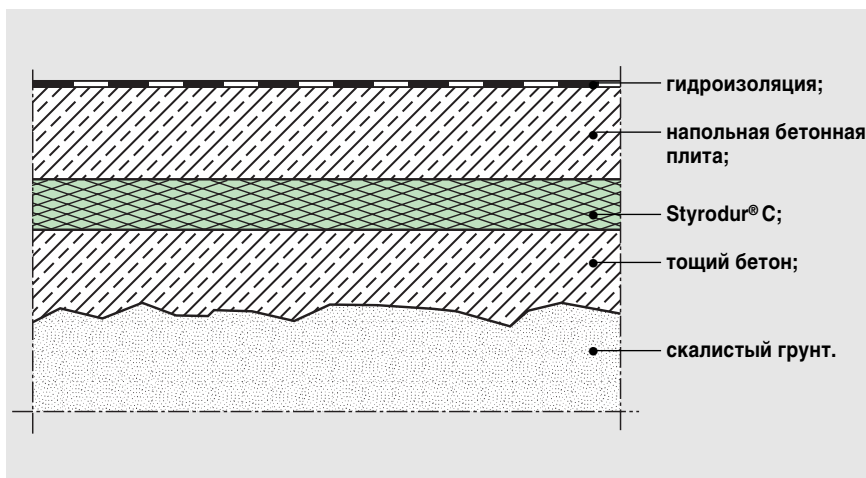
Выравнивающий слой из тощего бетона в строительном скалистом грунте.
